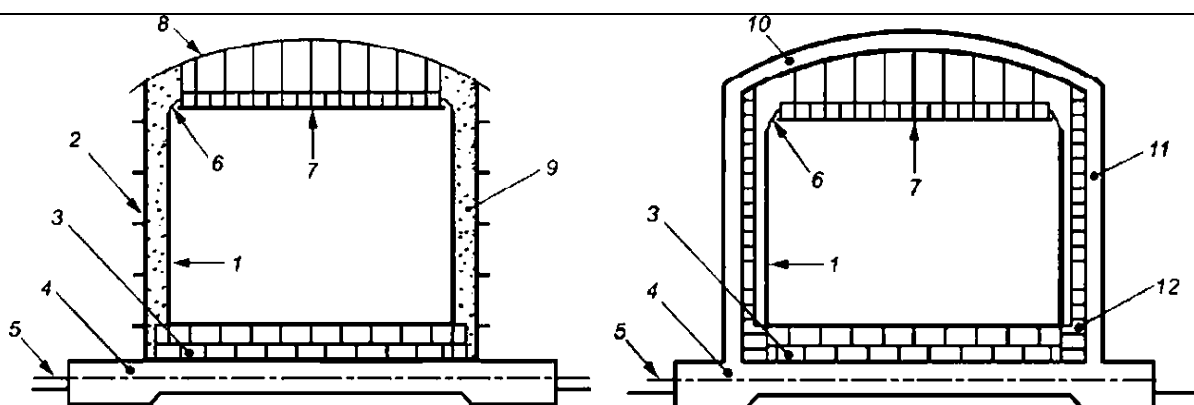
Примеры двухболоочечных резервуаров [4]:
